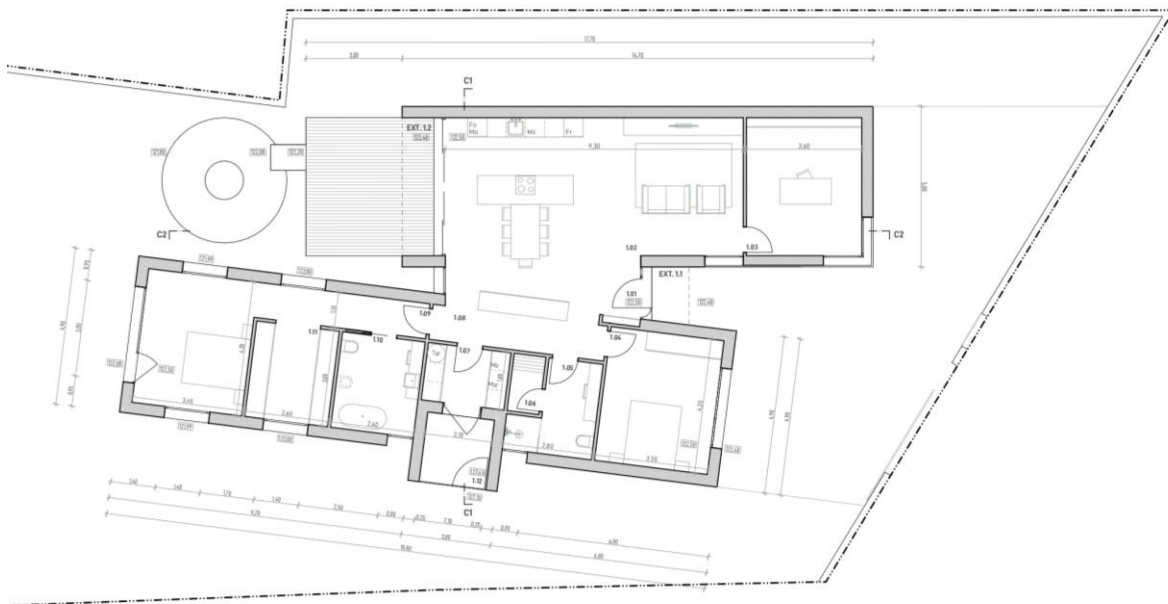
Planta Piso 1, Habitação Sintra. Fonte. FSA.
